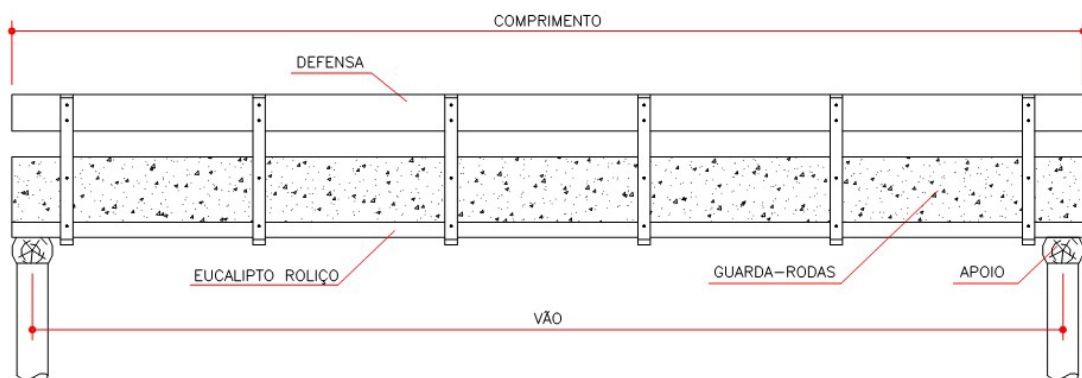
Vista lateral da ponte em placa mista madeira-concreto. Fonte: CALIL et al (2006).
